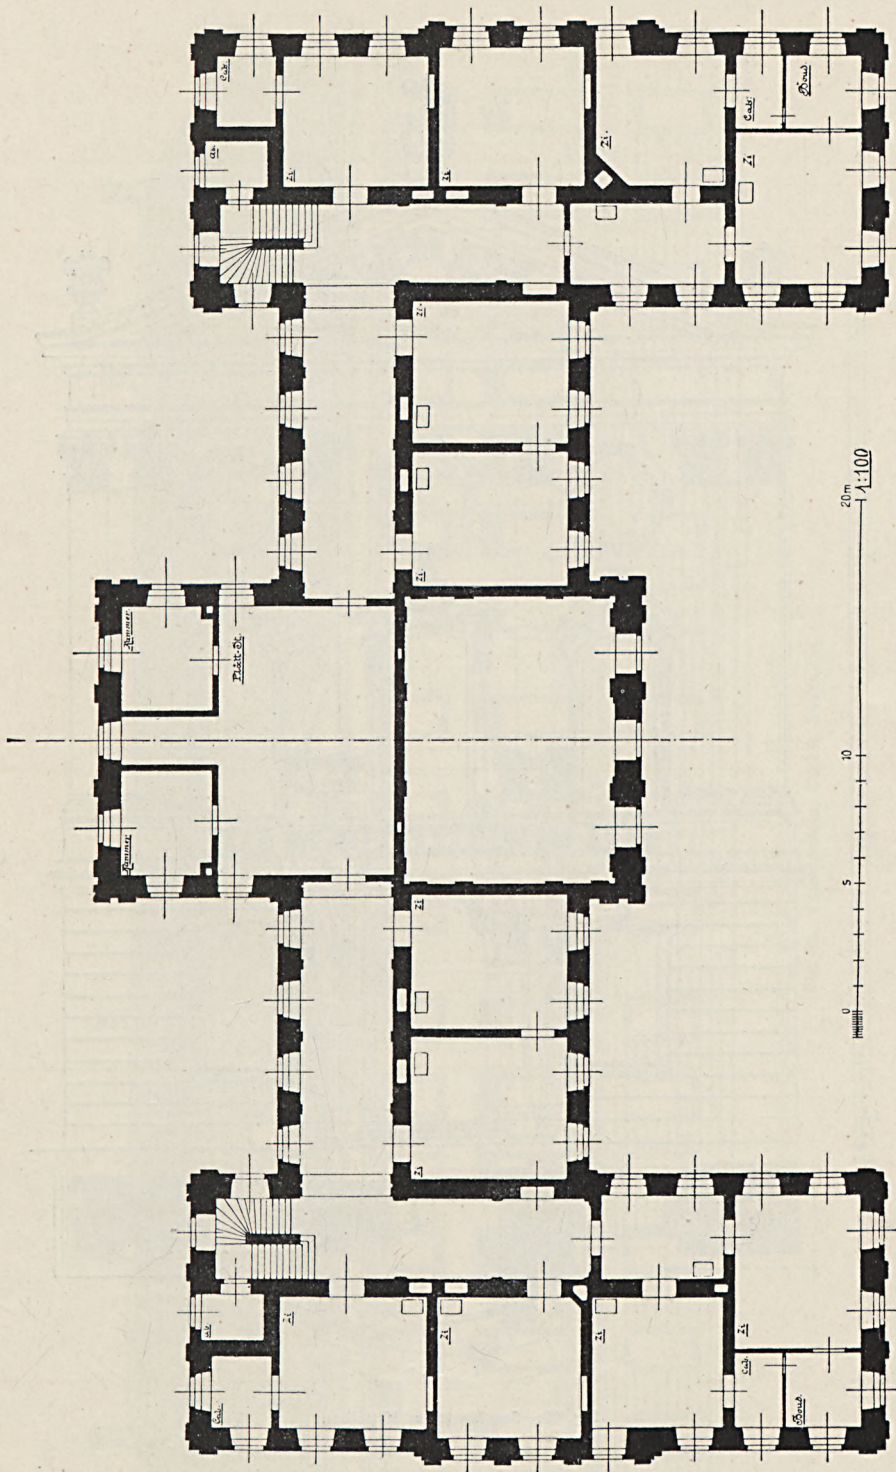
Joachimstein, Schloß, Grundriß des zweiten Obergeschosses.
